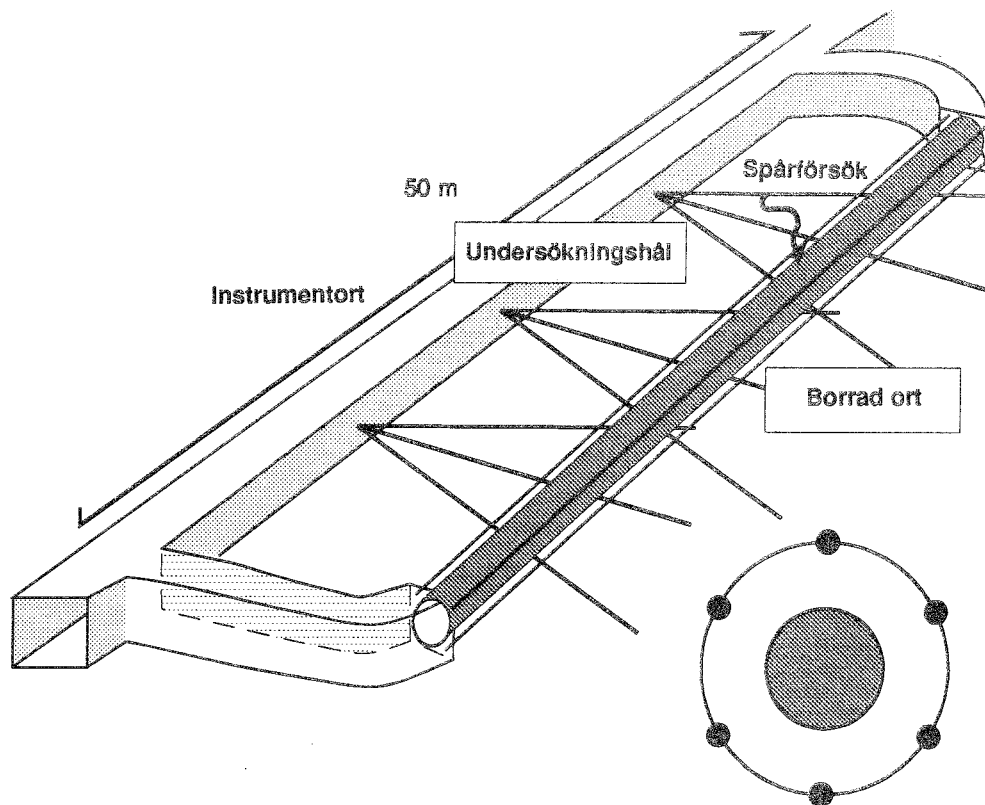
Tänk layout för en tunneleffektundersökning.
